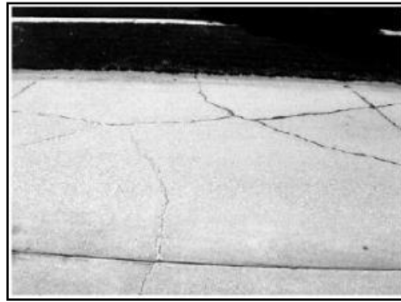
Esquema Losa Dividida- Pavimento Rígido
